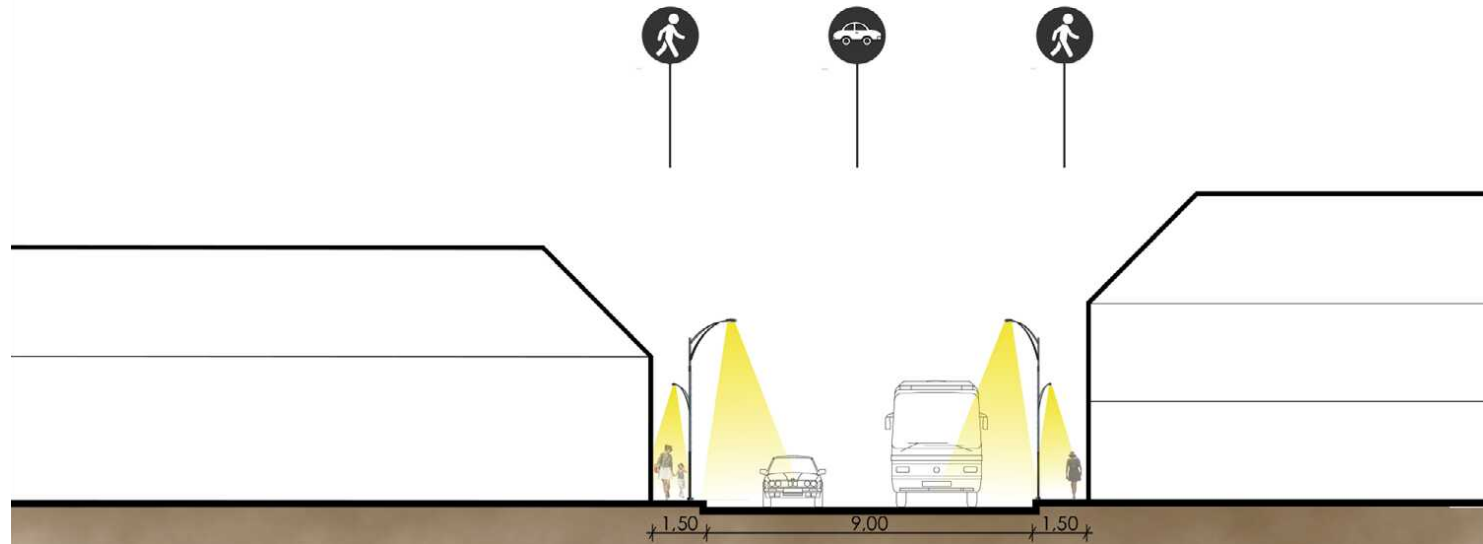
Sección vial Av 25 de Marzo - Estado actual.
